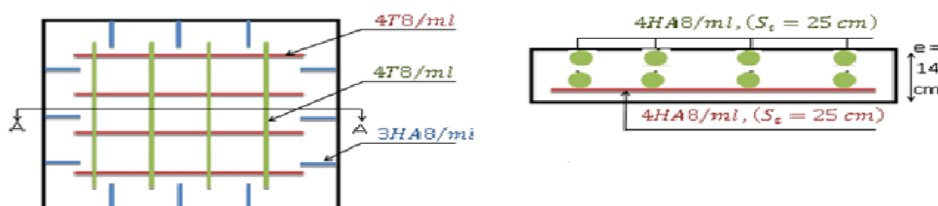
Schéma de ferrailage de la dalle salle de machine
